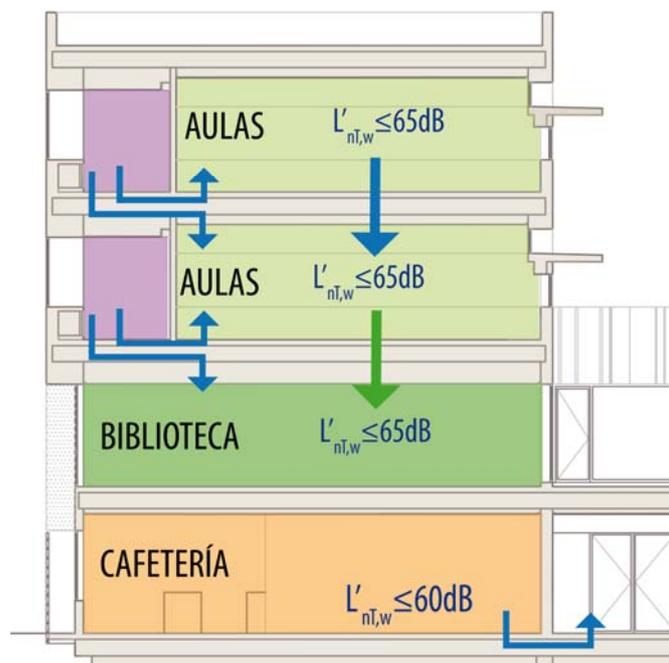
Detalle sección por la cafetería con indicación de exigencias aplicables a ruido de impactos.
